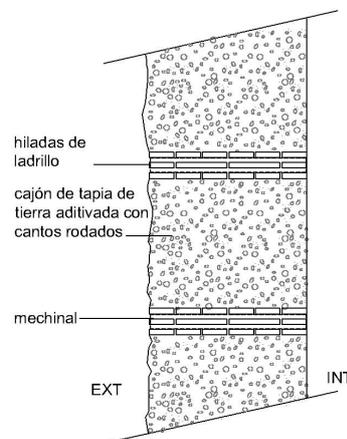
Esquema de sección del muro Norte de la iglesia de San Boal en Pozaldez. AV.
